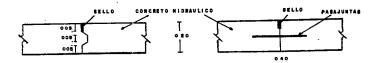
JUNTA LONGITUDINAL MACHIMBRADA.
